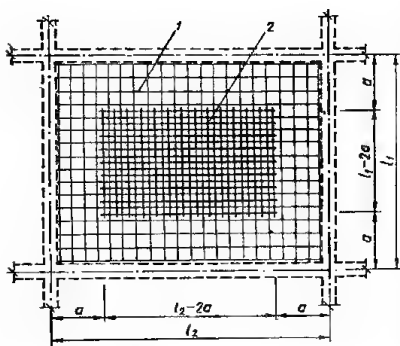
План нижней арматуры плиты, работающей в двух направлениях:
